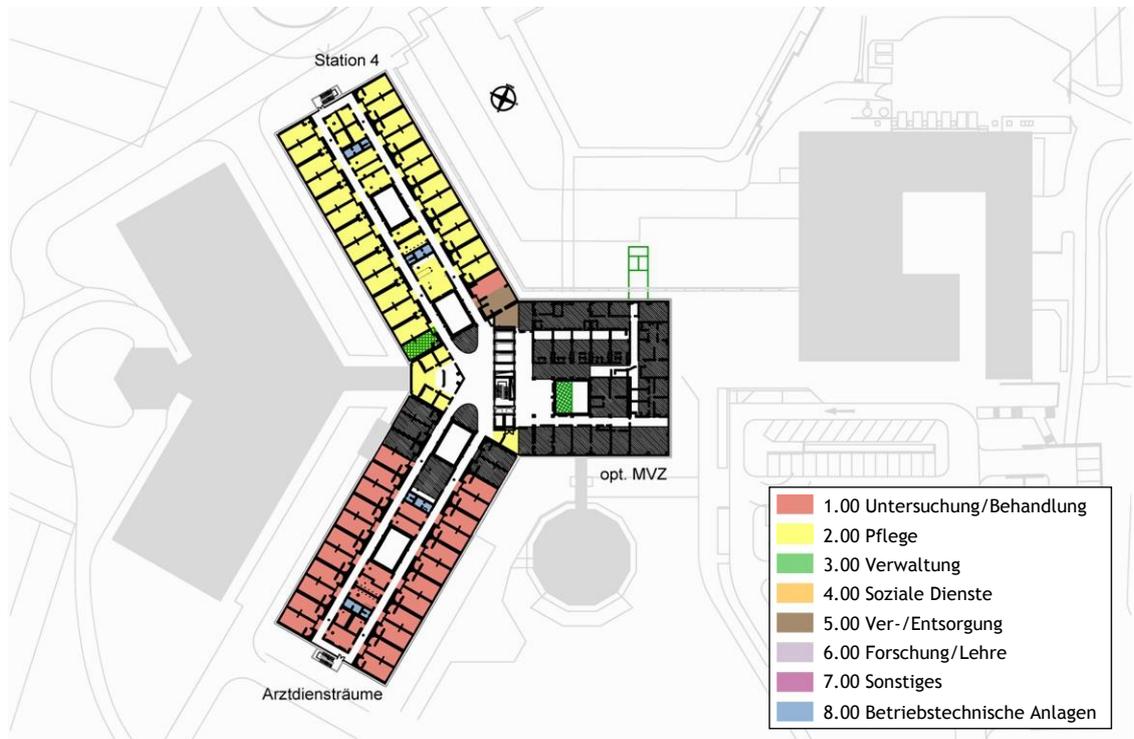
SOLL-Flächen nach DIN 13080 - 1.Obergeschoss
